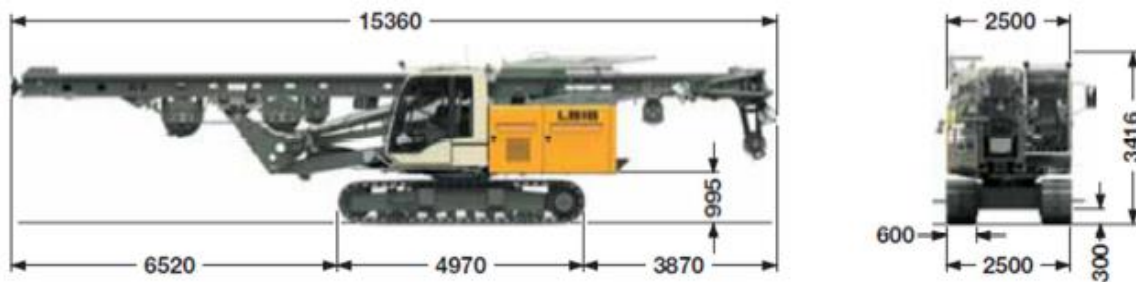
7.1.5 - Pilotovací souprava Liebherr 16-180
